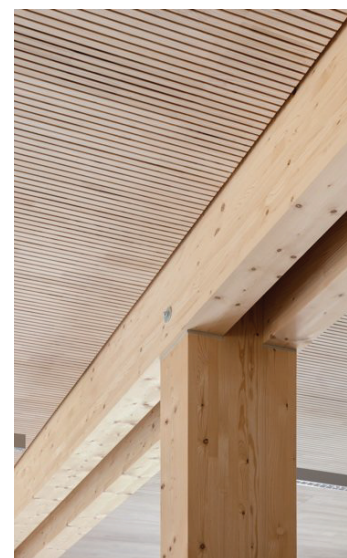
(rechts) Detailpunkt Stützenkopf, Fotograf hiepler brunier <https://www.hiepler-brunier.de/>
